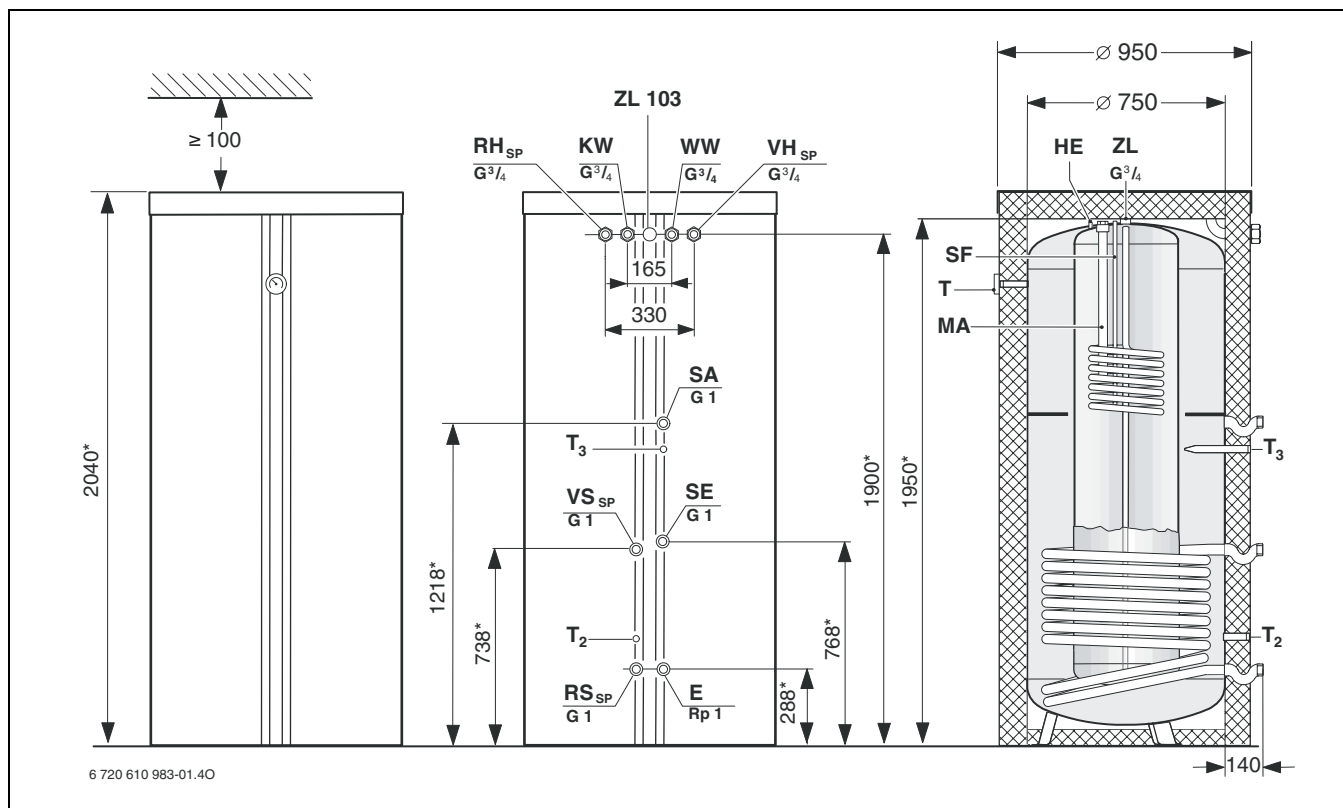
Габаритные и присоединительные размеры WST SP 750 solar
